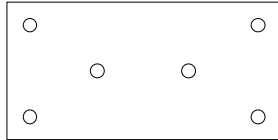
Plans de chevillage - panneaux de dimensions 1000 × 500 mm
